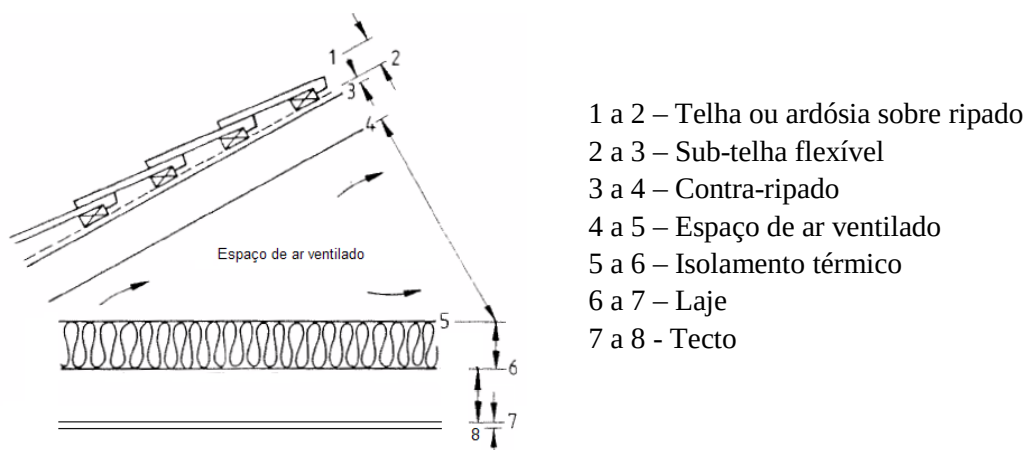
Constituição de coberturas em desvão ventilado [2]
